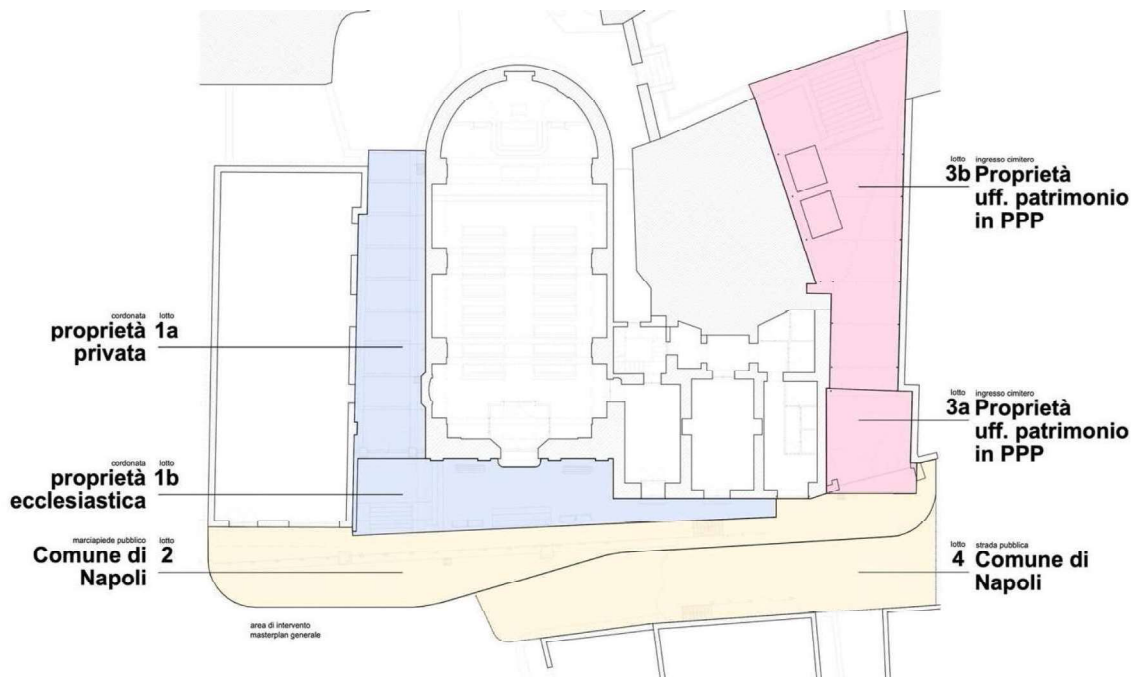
Schema identificativo proprietà lotti di intervento – progetto masterplan generale
